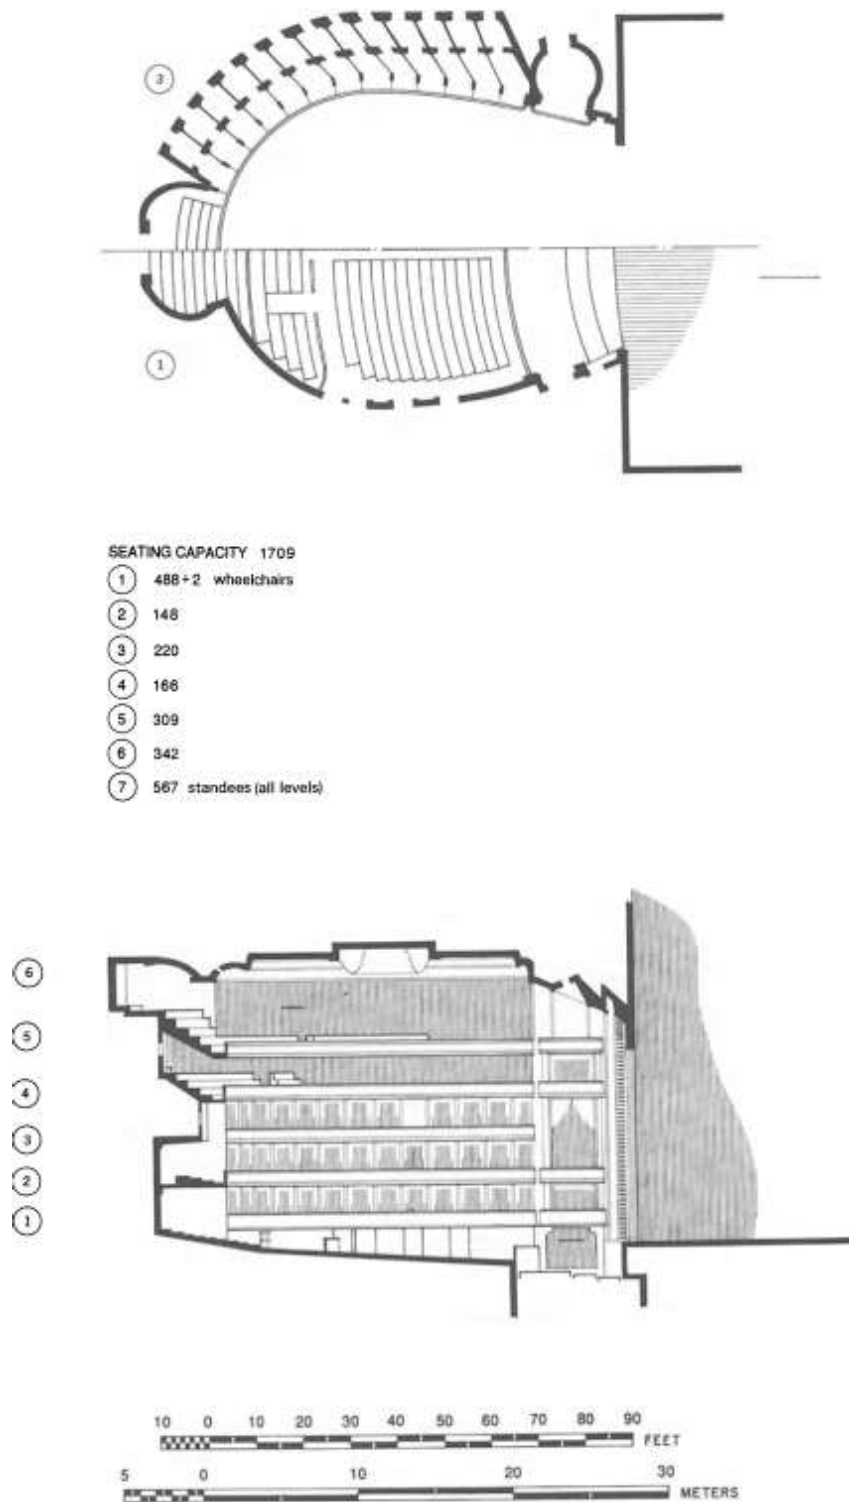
Grundriss und Seitenansicht Wiener Staatsoper [Beranek 2004, S. 183]
